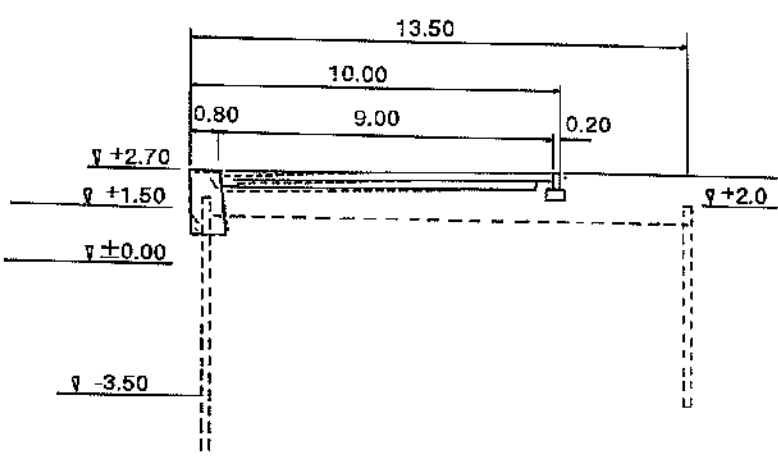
標準断面図 (船溜・漁港地区, ㊸~㊹物揚場(-3.0m))
